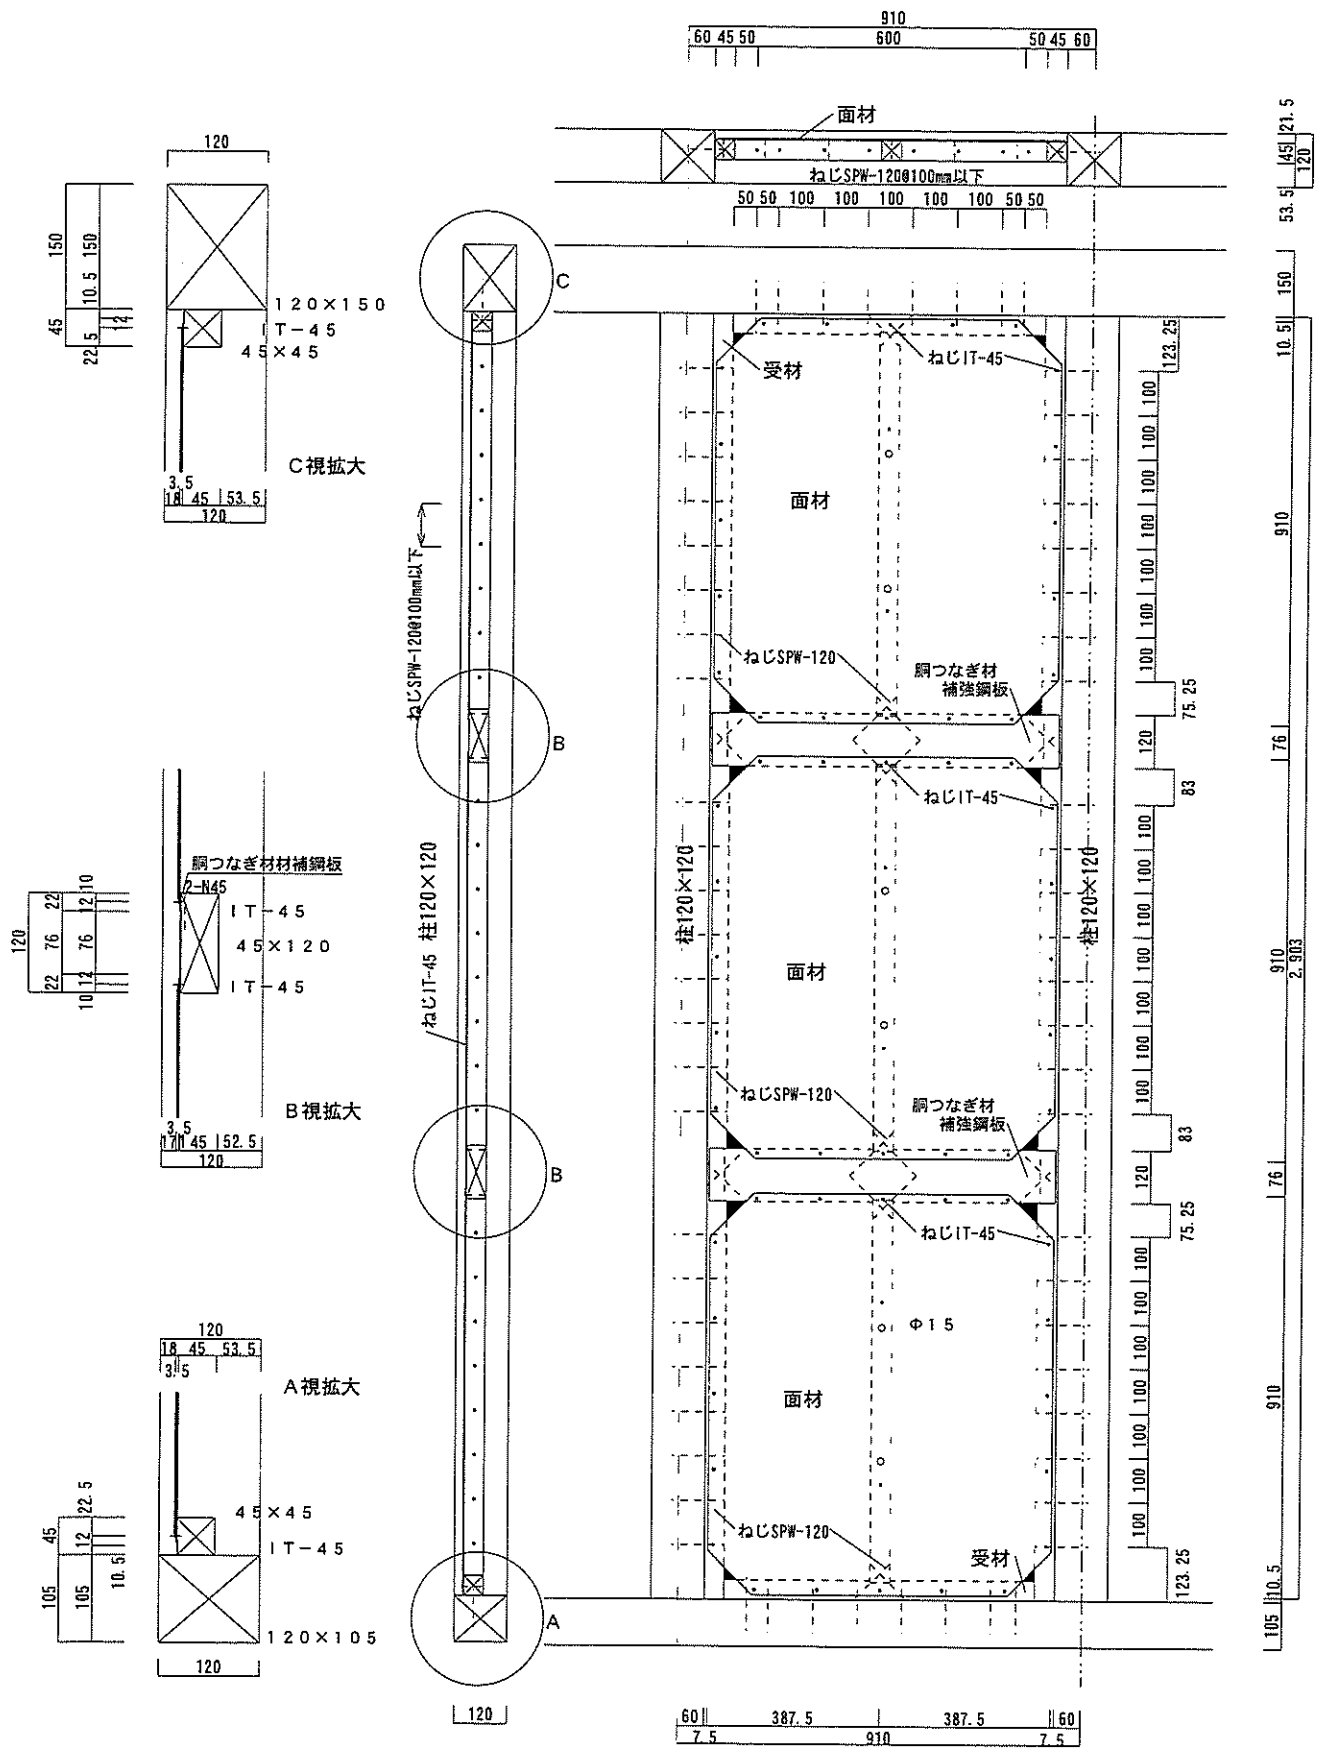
施工図 (柱寸法: 120×120mm、壁高さ最大時) (寸法単位: mm)
